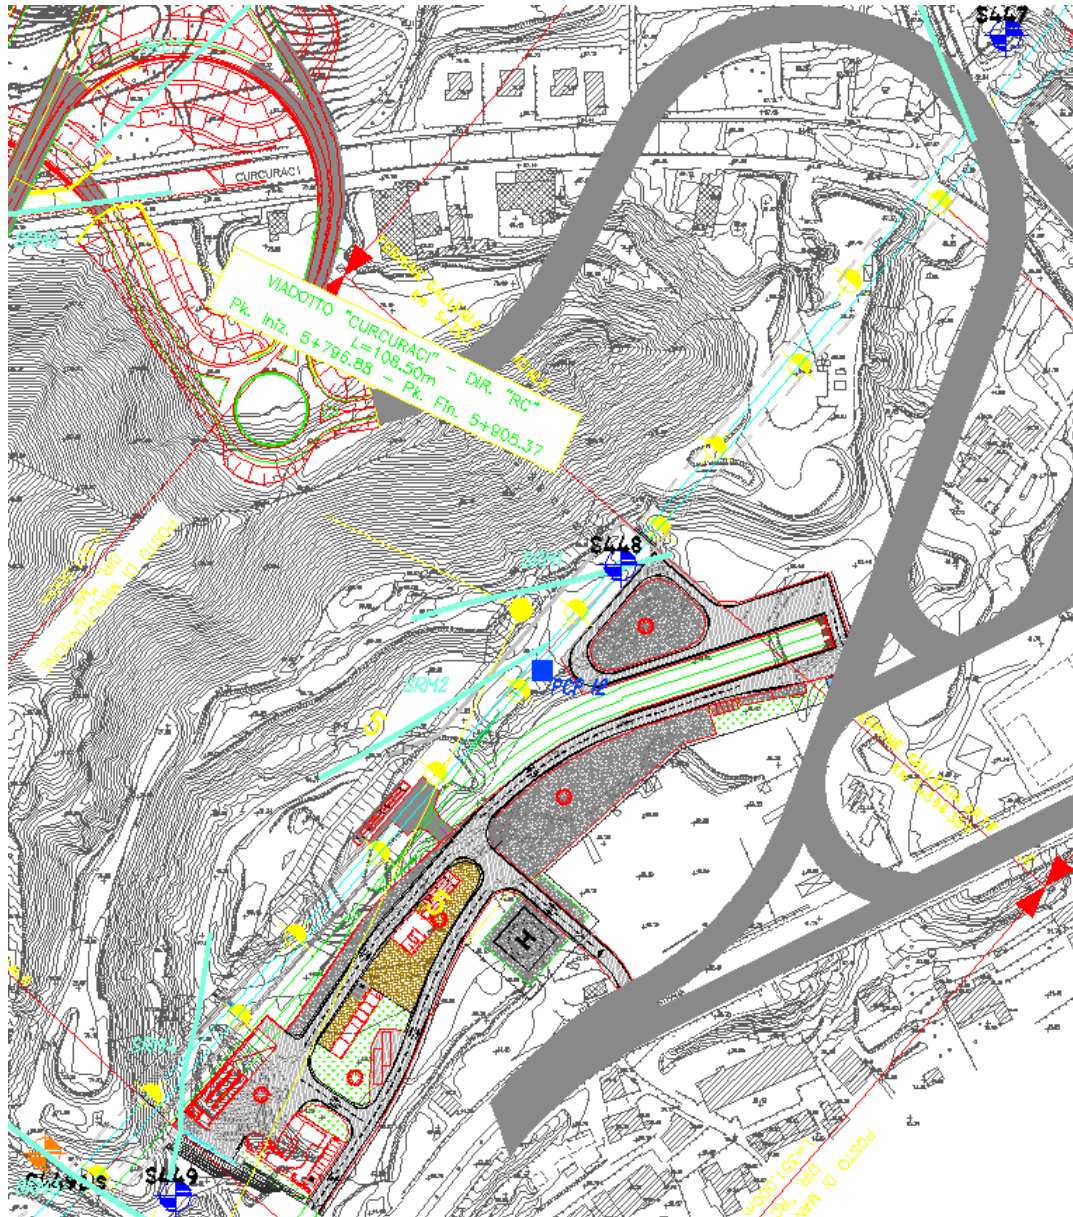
stralcio planimetrico del posizionamento dei sondaggi
